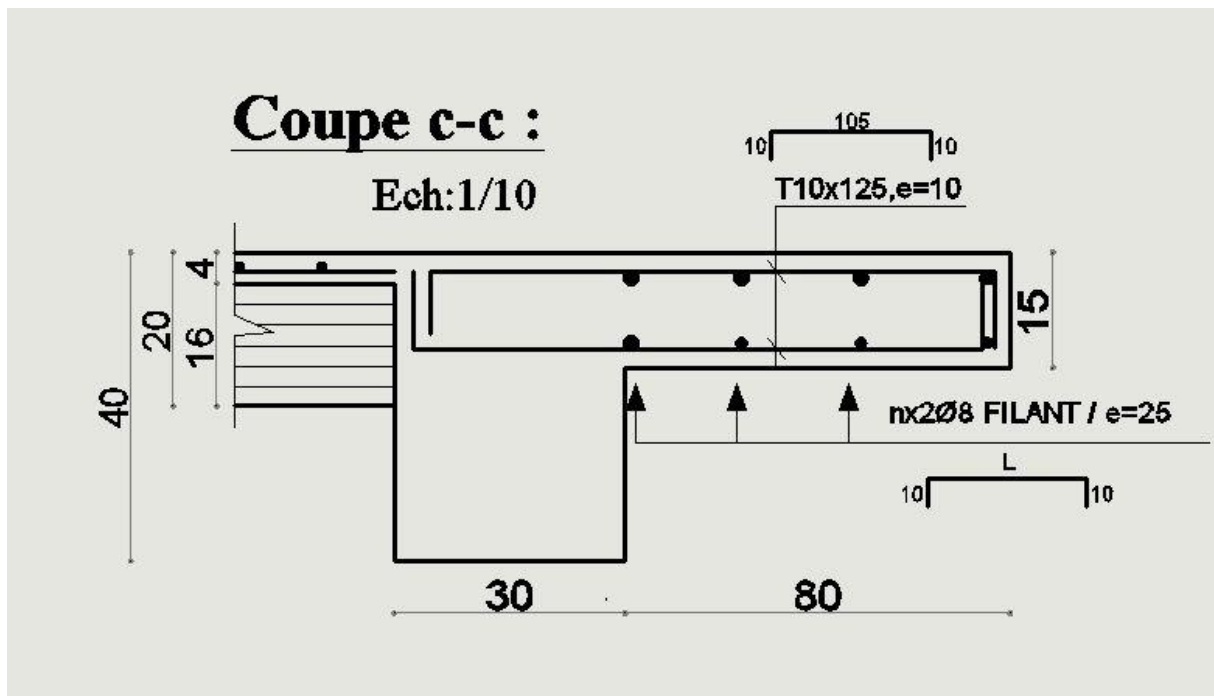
N°10: Schéma de ferrailage du balcon type 02.
